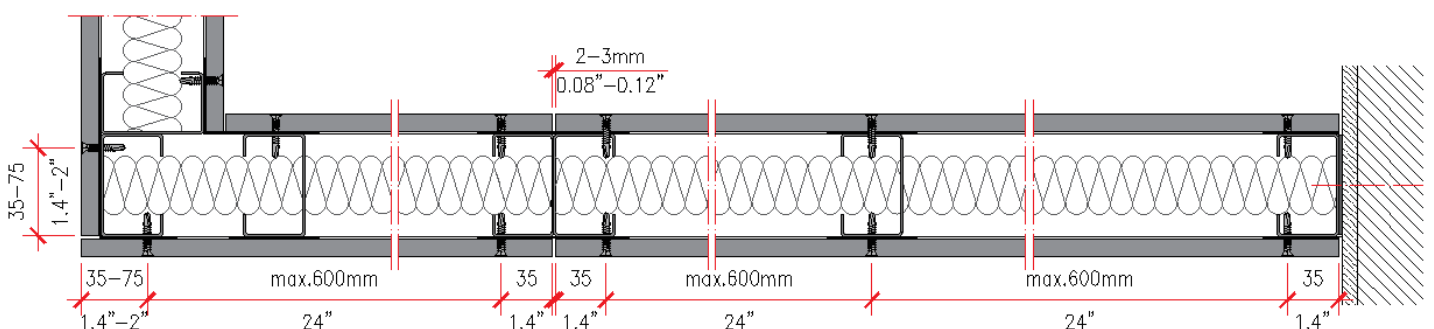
Secção horizontal da parede, estrutura de aço galvanizado
